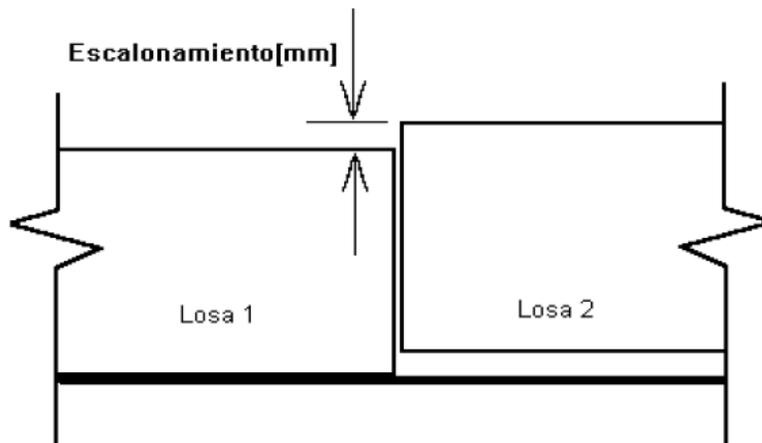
Esquema de un escalonamiento en pavimento de hormigón.
